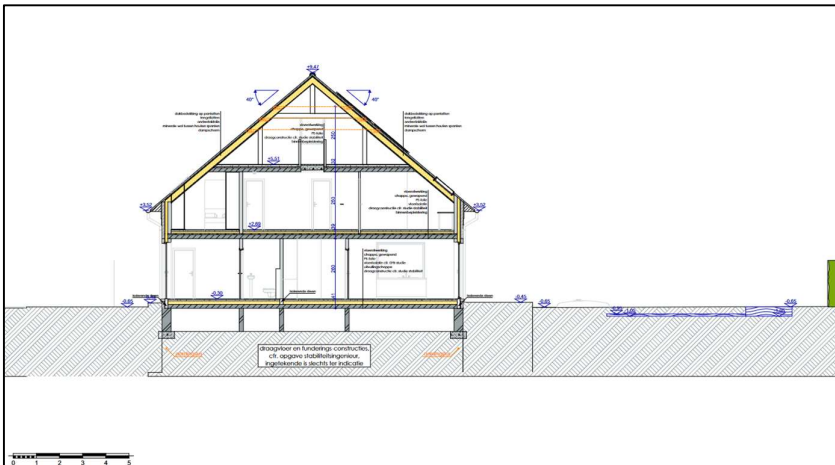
Fundering woonblok 1 met drie woonunits en nutsvoorzieningen (bron: opdrachtgever)
